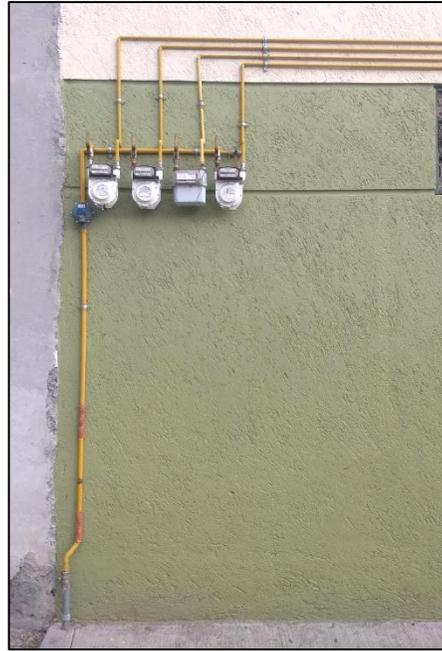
Instalación de ductos al exterior de un edificio (foto original tomada en campo).
